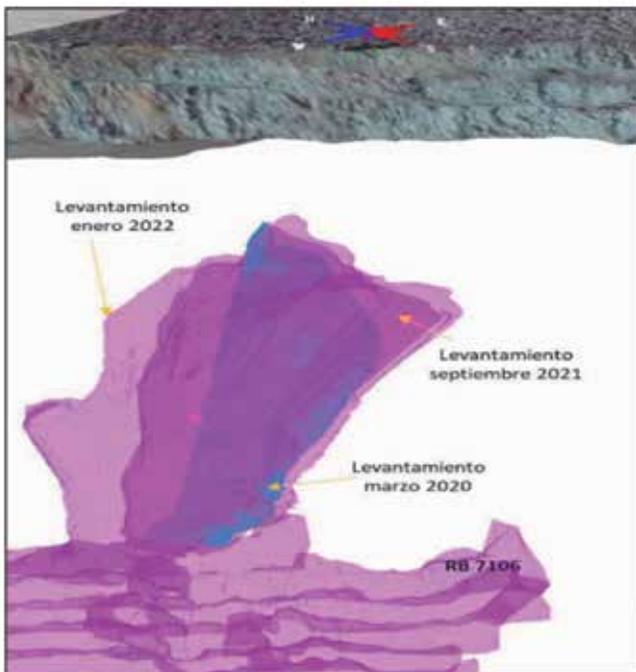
Levantamiento con el escáner CMS de la cavidad del rebaje 7106
